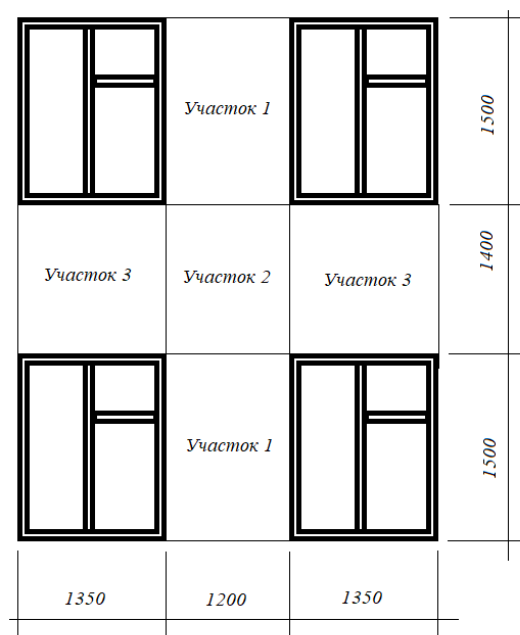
Фрагмент наружной стены здания с разбиением на участки
